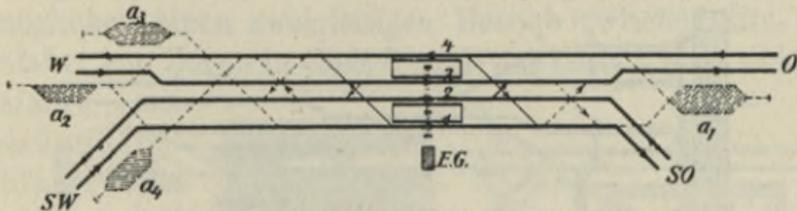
Berührungsbahnhof mit Linienbetrieb.
